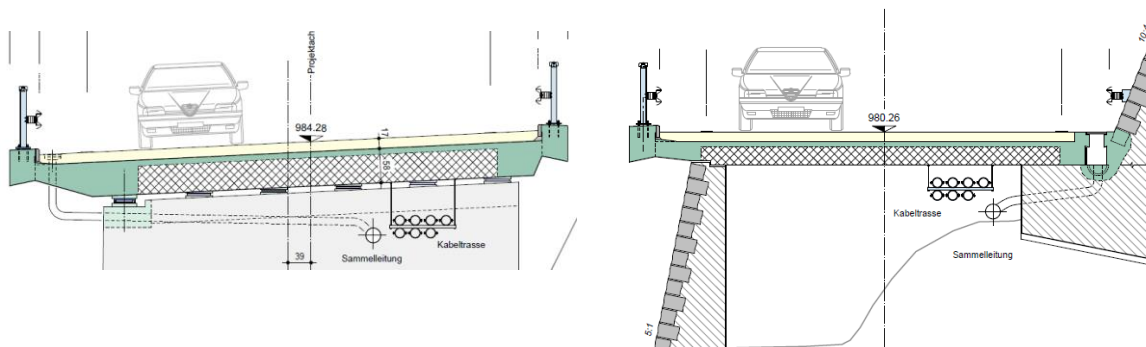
Normalquerschnitt Brücken und Betonplatte, Projekt „Sareggio“
